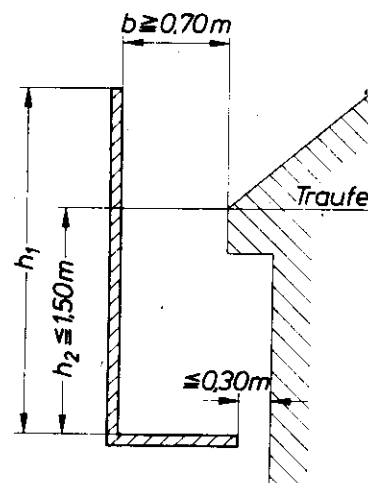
Vertikale und horizontale Begrenzungen bei Dachfanggerüsten
